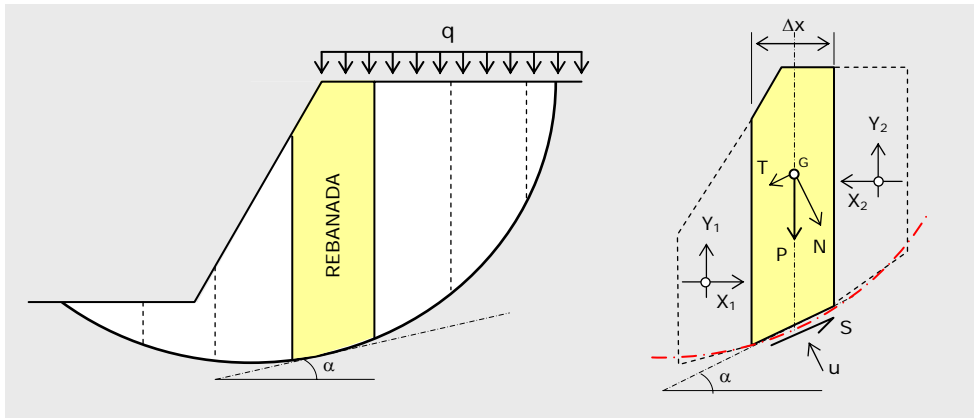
Estado de fuerzas actuantes en una rebanada de terreno
